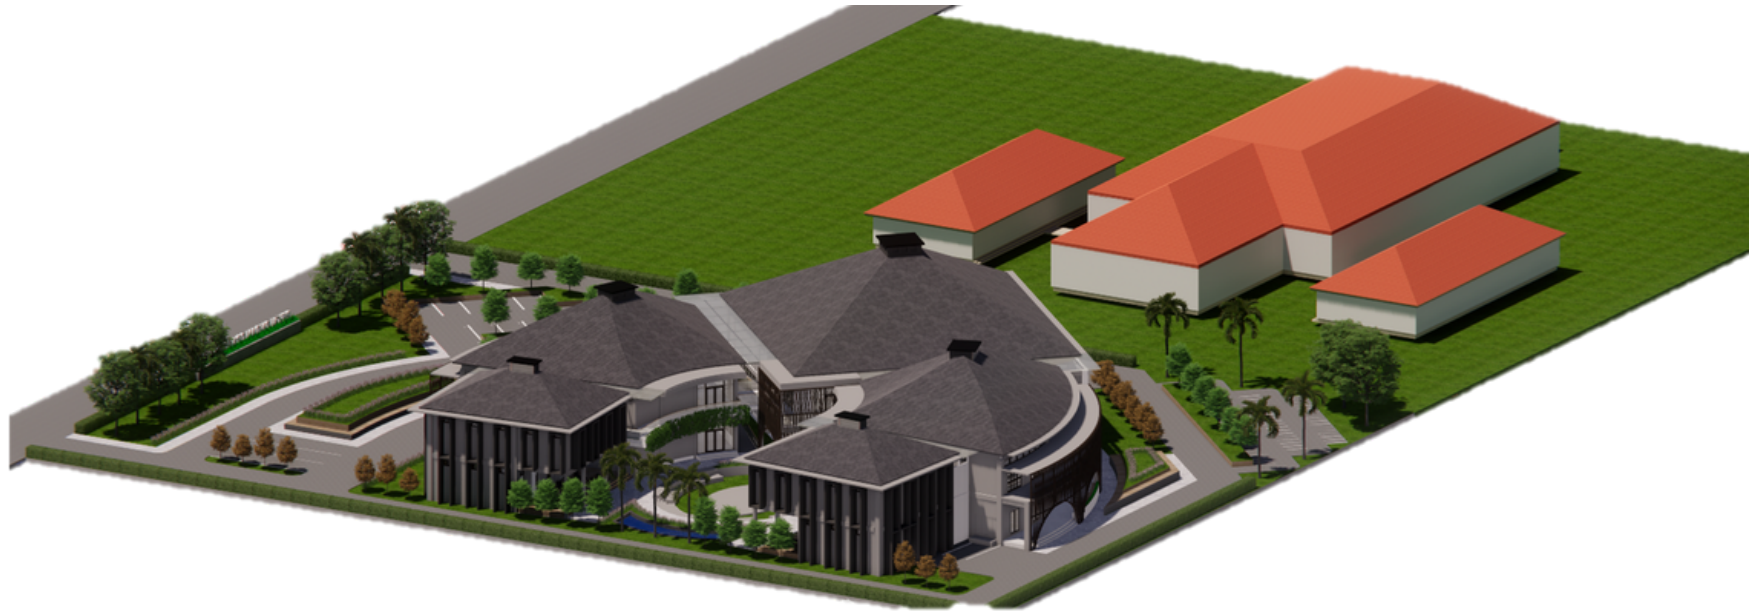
Siteplan Galeri Kerajinan Pekalongan
